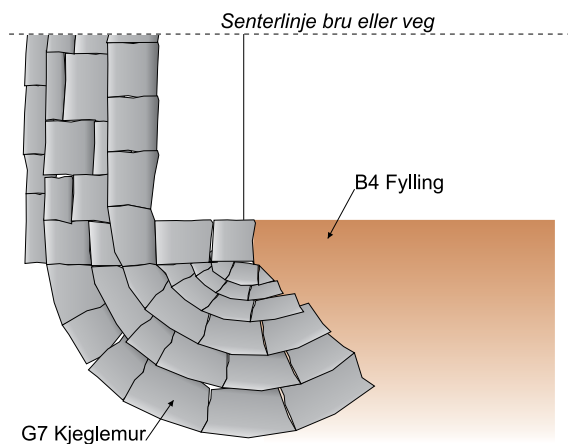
Element G Støttekonstruksjon, typiske elementer i støttemur
